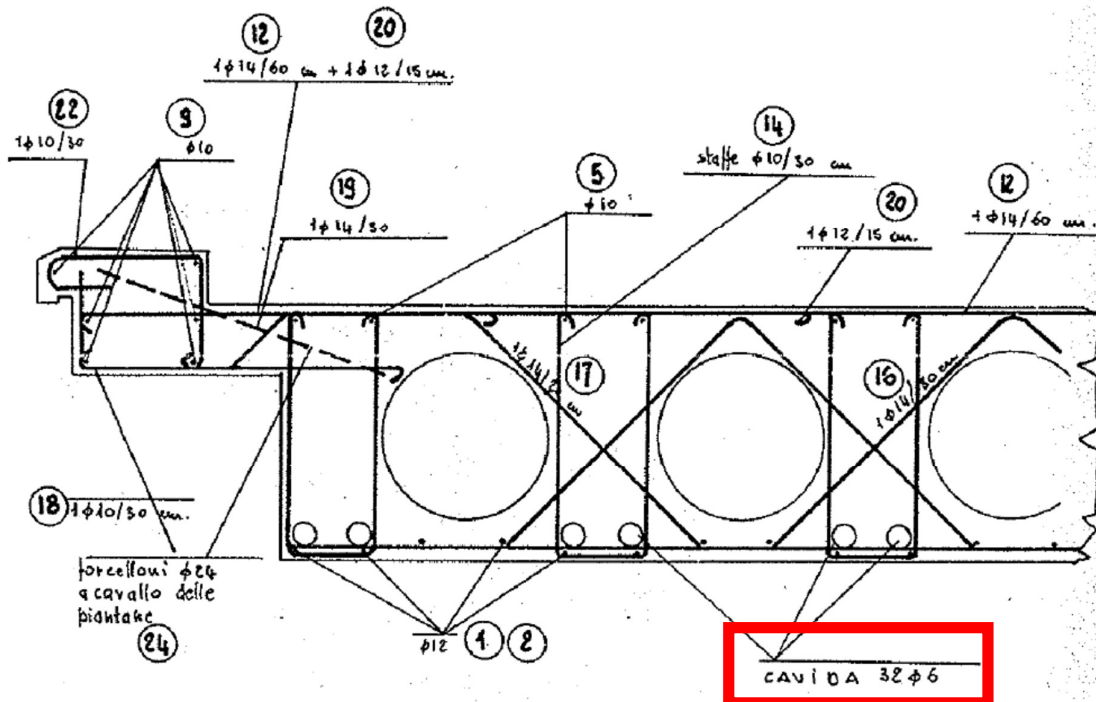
Sezione trasversale della soletta con armature (Tavole di progetto opera originale)
